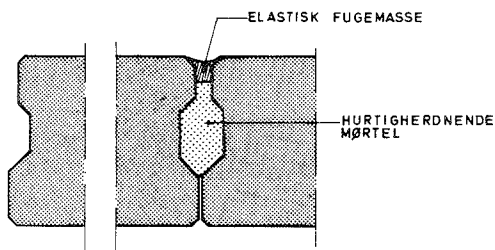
Detalj fuge i tak med elastisk fugemasse.
